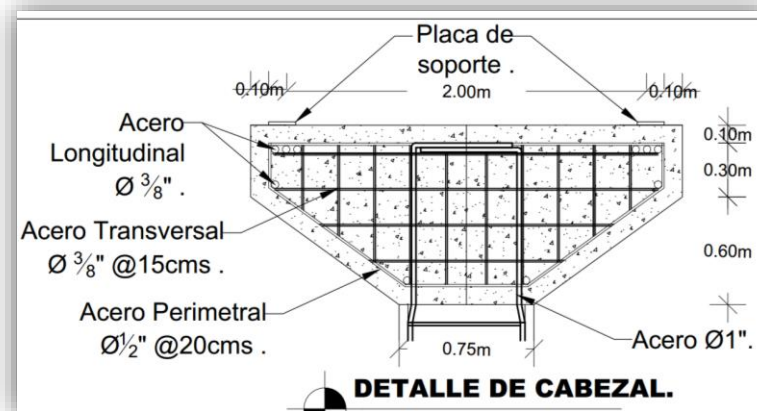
Detalle de plano para colocación de acero de refuerzo en el cabezal.
